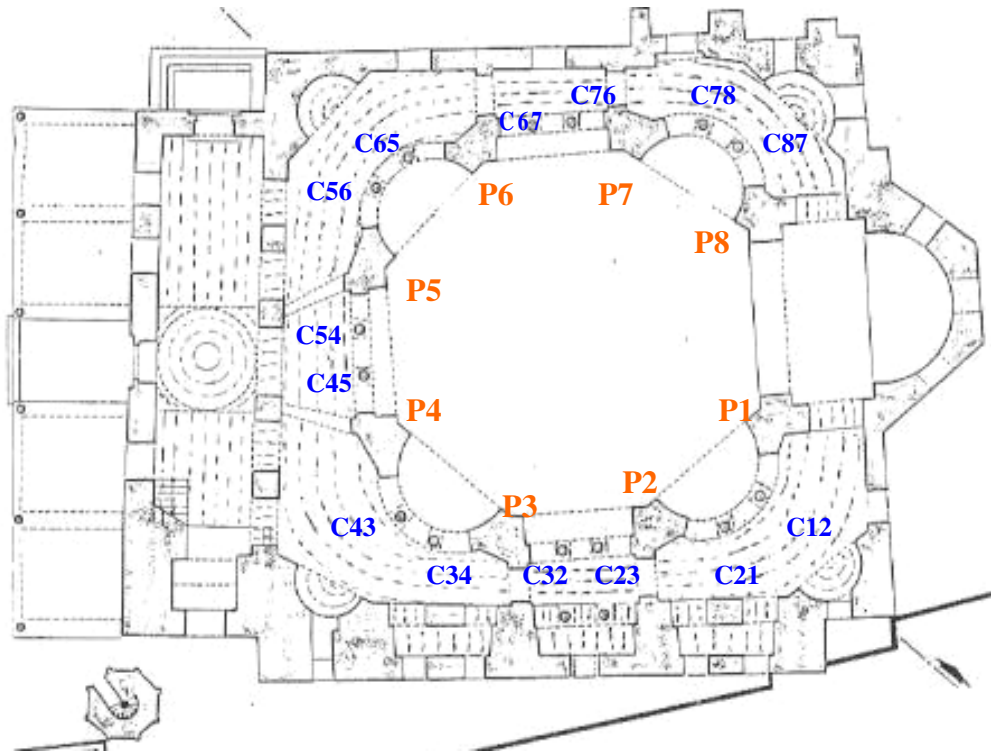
Planta con la nomenclatura utilizada (elaboración propia)
